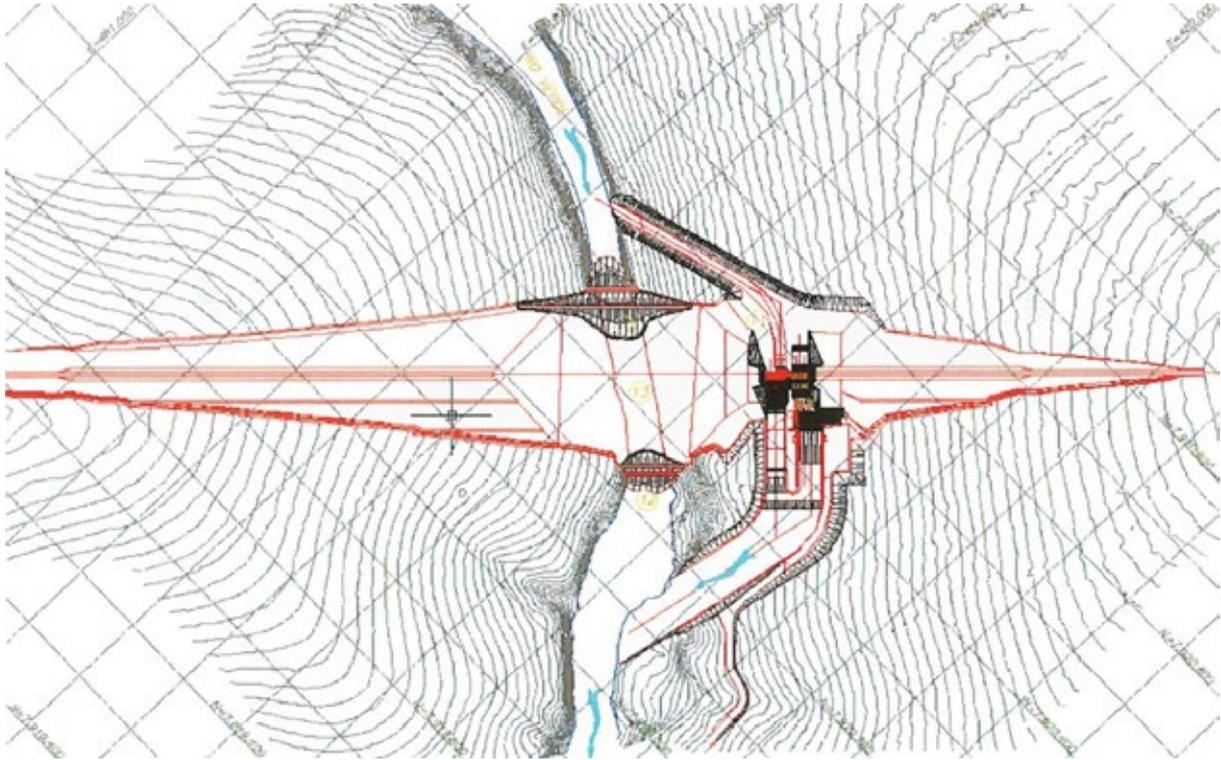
Desvio do rio feito em uma única fase. Desvio do rio feito pelas galerias de desvio. Leito ensecado com as ensecadeiras de montante e de jusante UHE Salto, GO.
